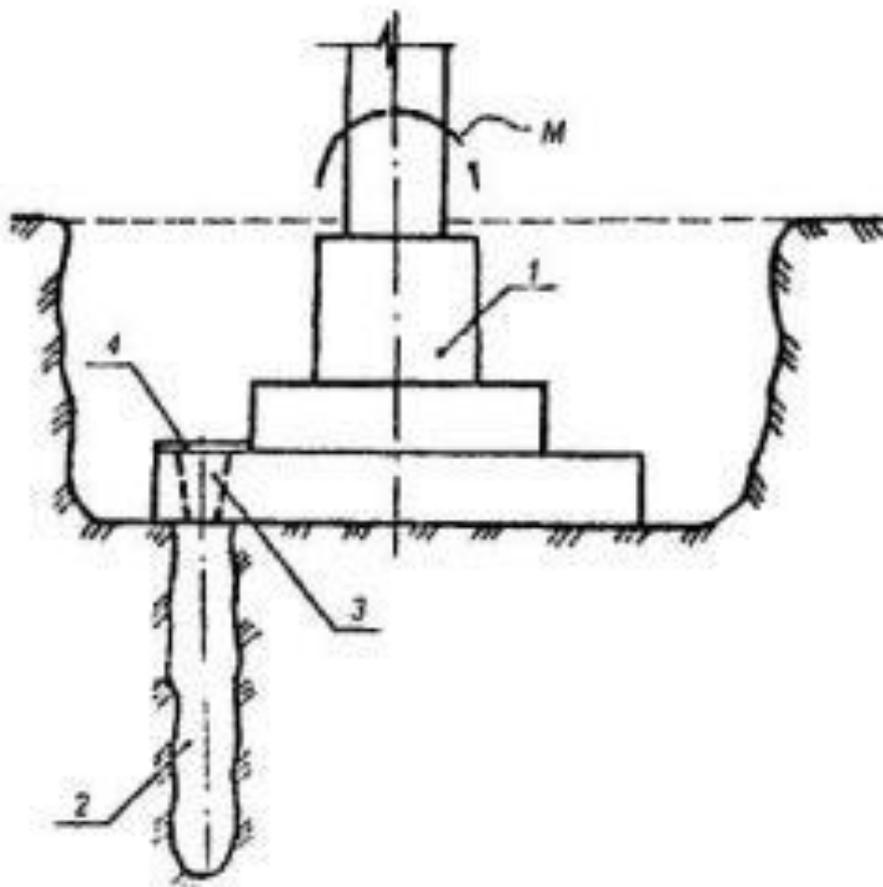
1 - усиливаемый столбчатый фундамент; 2 - анкеры из буронабивных армированных свай, работающих на выдергивание (диаметр свай 150-200 мм, длина 2-3 м); 3 - конусные отверстия в плитной части фундамента, заполняемые в последующем бетоном; 4 - металлические пластины, к которым приваривается арматура анкеров.
